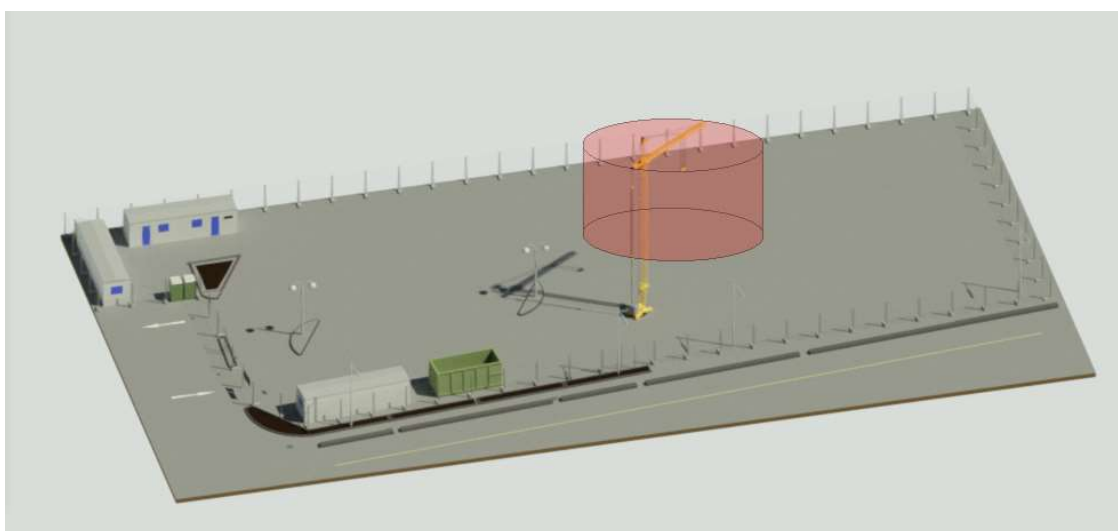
Effettivo volume occupato dall’oggetto “gru a torre” in posizione fissa.
